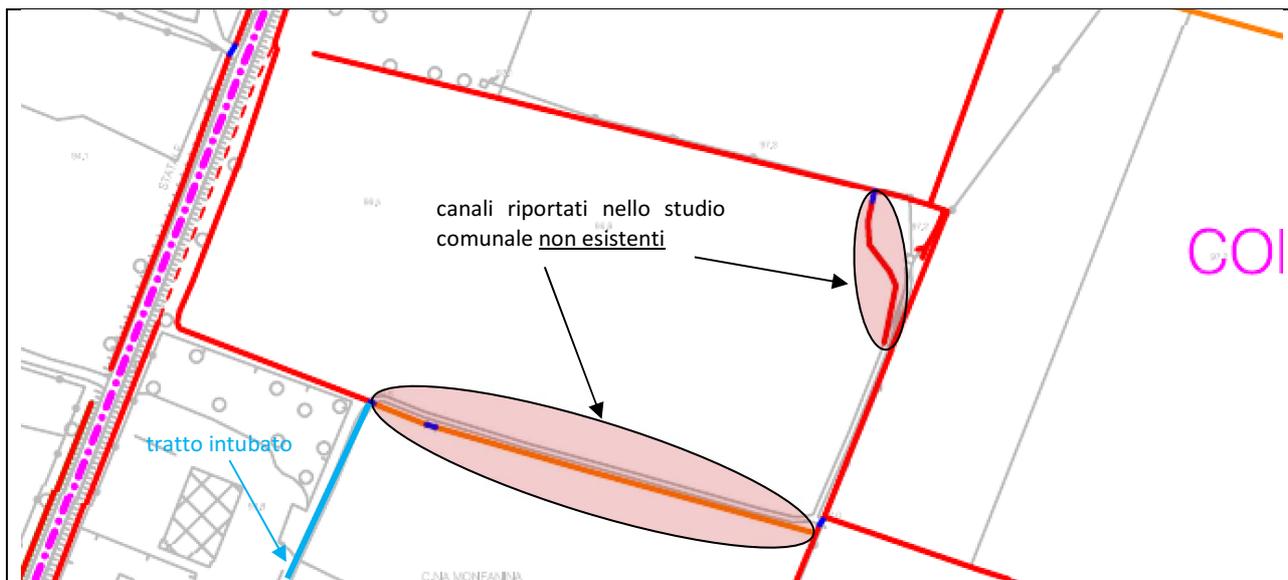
stralcio della planimetria di rilievo (fonte: studio per l'identificazione del reticolo idrico minore) con osservazioni
